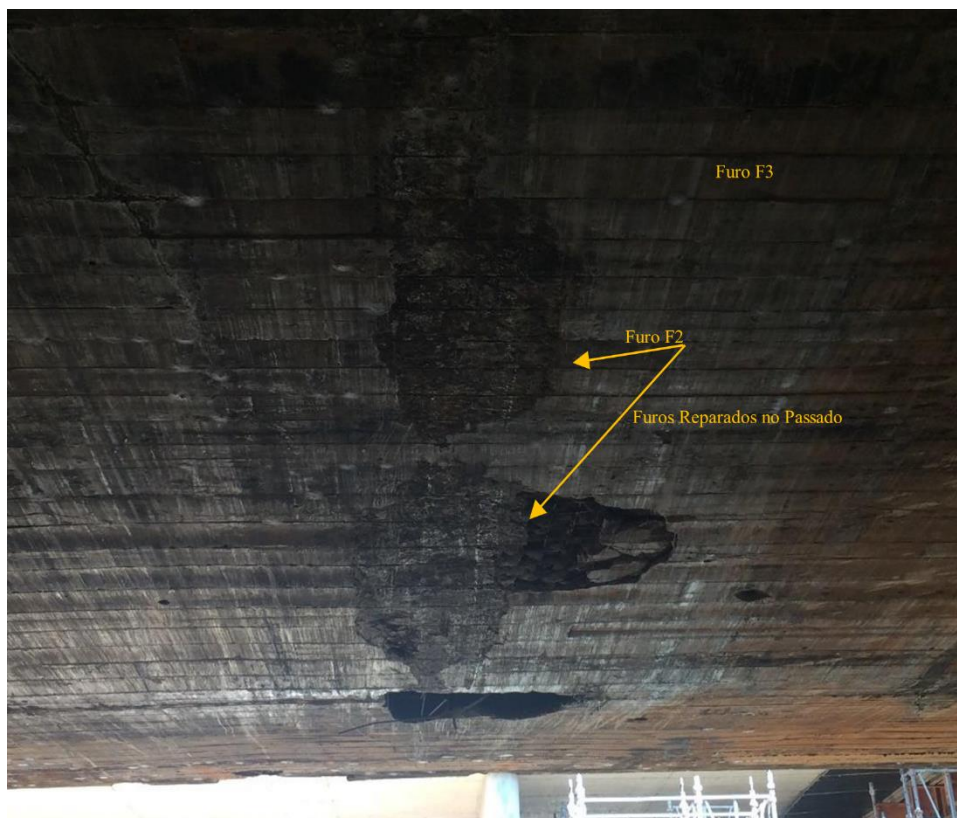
Furo na Laje Inferior do Tabuleiro (F1)
